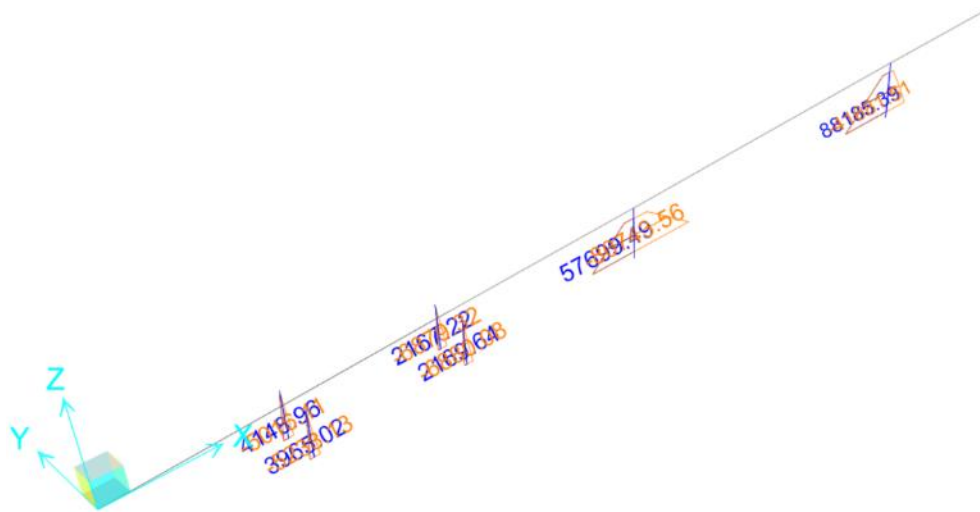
Diagrama momento longitudinal (KN.m) de las columnas puente San Pedro
